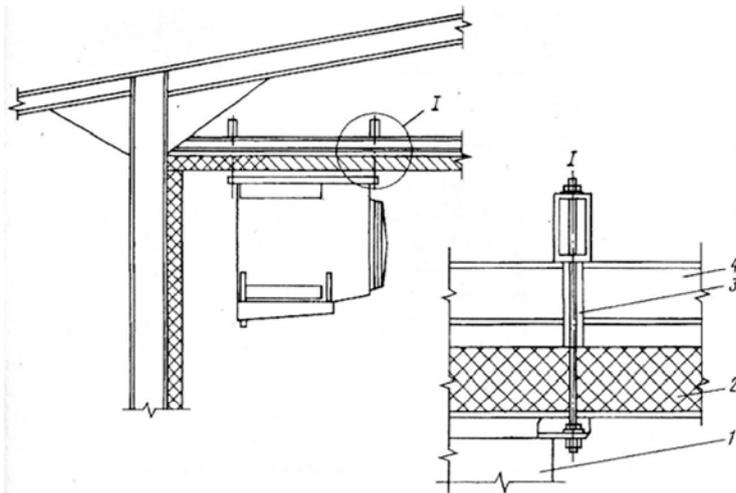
Крепление подвешеного воздухоохладителя к металлическим несущим конструкциям:
